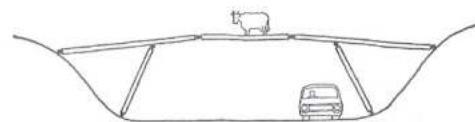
Puente en voladizo con una viga apoyada en el tramo central.
